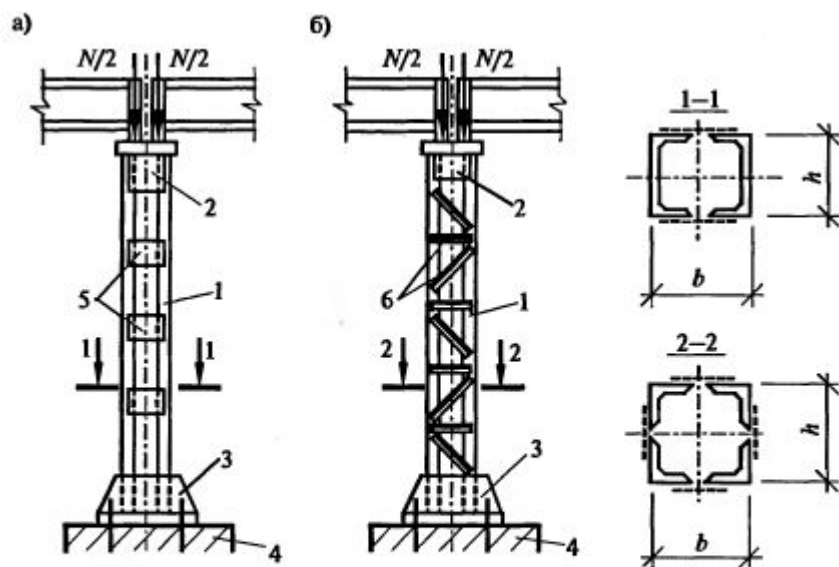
Сквозные центрально-сжатые колонны: а) соединение ветвей на планках; б) соединение ветвей решеткой из уголков; 1 — стержень; 2 — оголовок; 3 — база колонны; 4 — фундамент; 5 — планки; 6 — уголки
